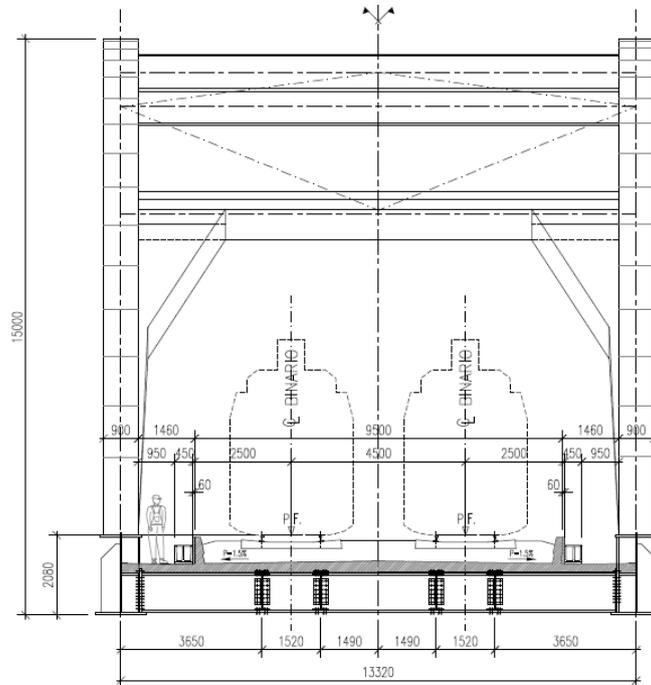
Sezione trasversale tipo dell'impalcato metallico.
